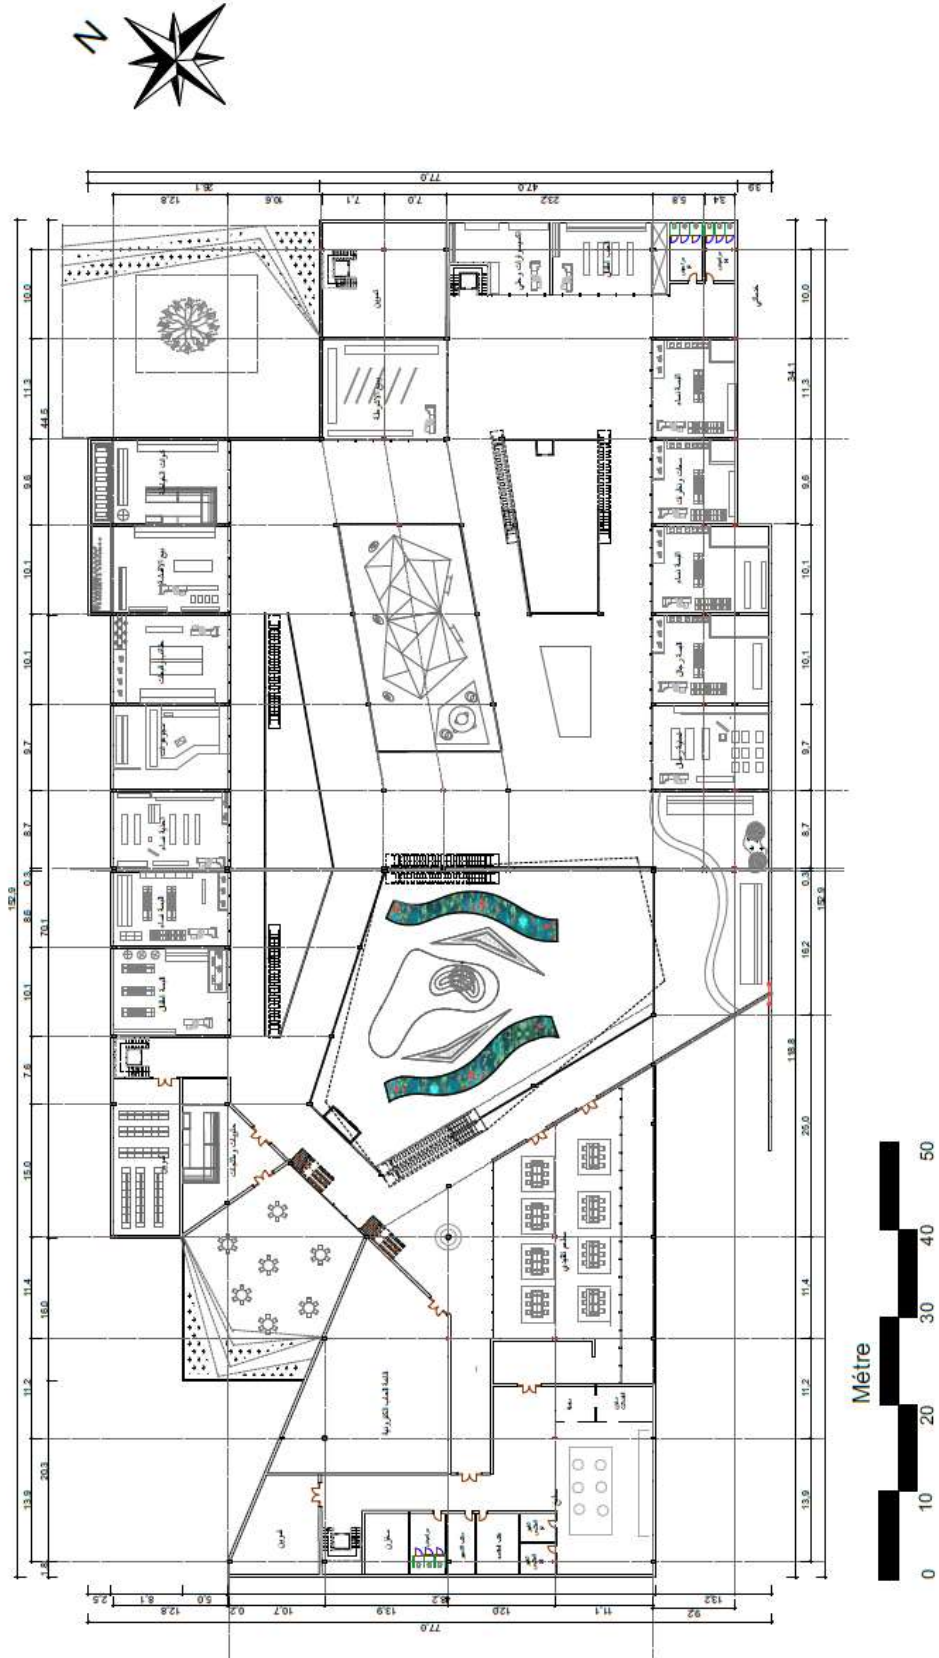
مخطط الطابق التحت الأرضي 1-
